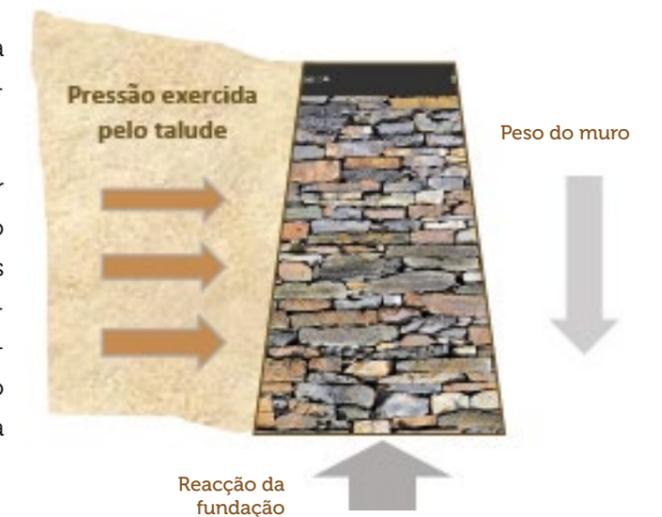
Pressões exercidas sobre o muro de pedra. (Ilustração adaptada de Guide technique de la Pierre sèche (GAL de l'Ourthe))
